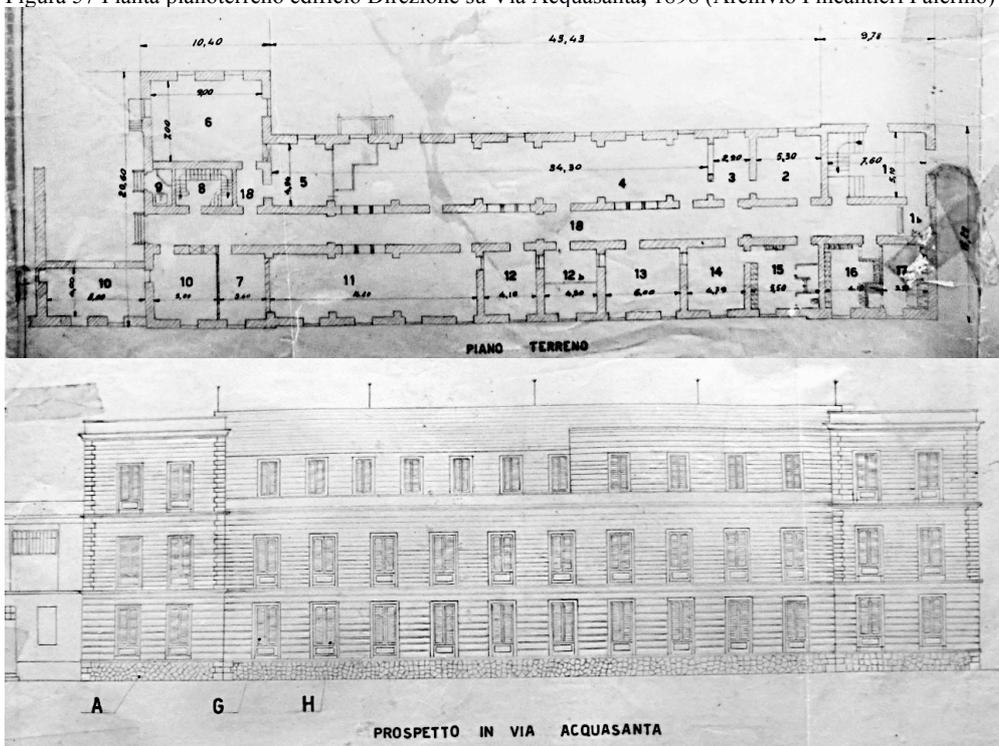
Pianta piano terreno e prospetto su Via Acquasanta, fabbricato Direzione, 1932. Fonte AFPA
